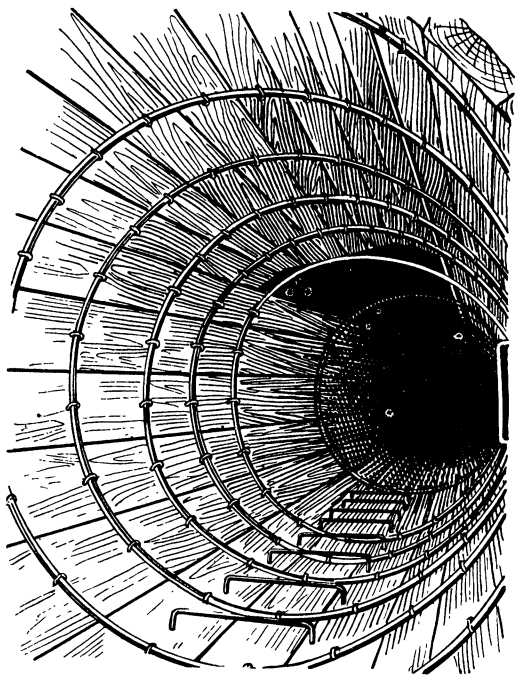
Крепление шахты круглого сечения вертикальными досками с кольцами из арматурного железа
